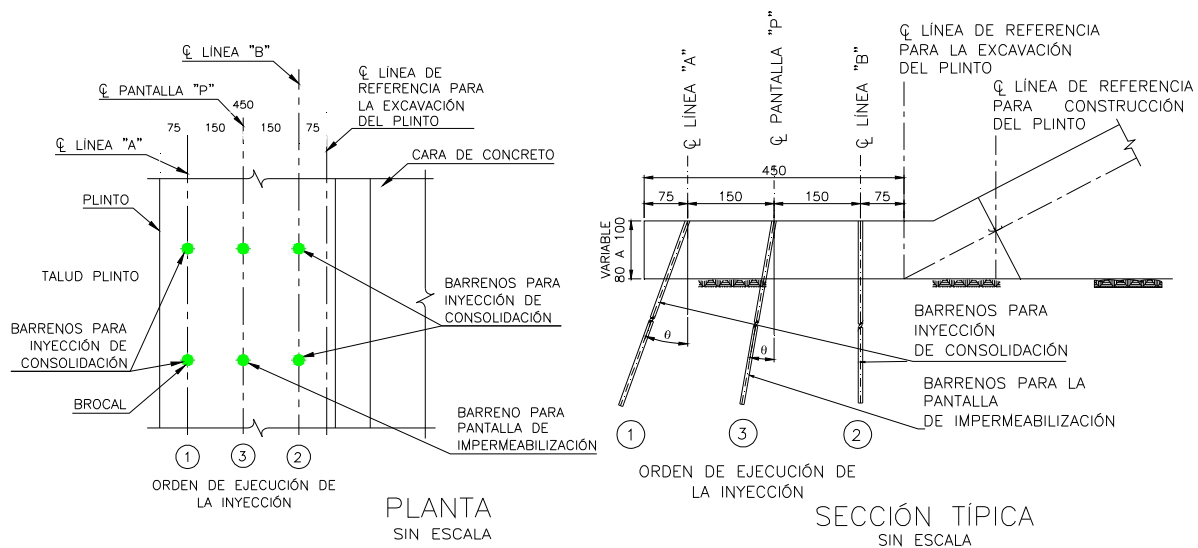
Planta y sección del Plinto y distribución de los barrenos de inyección en el tramo P10-P11'.
